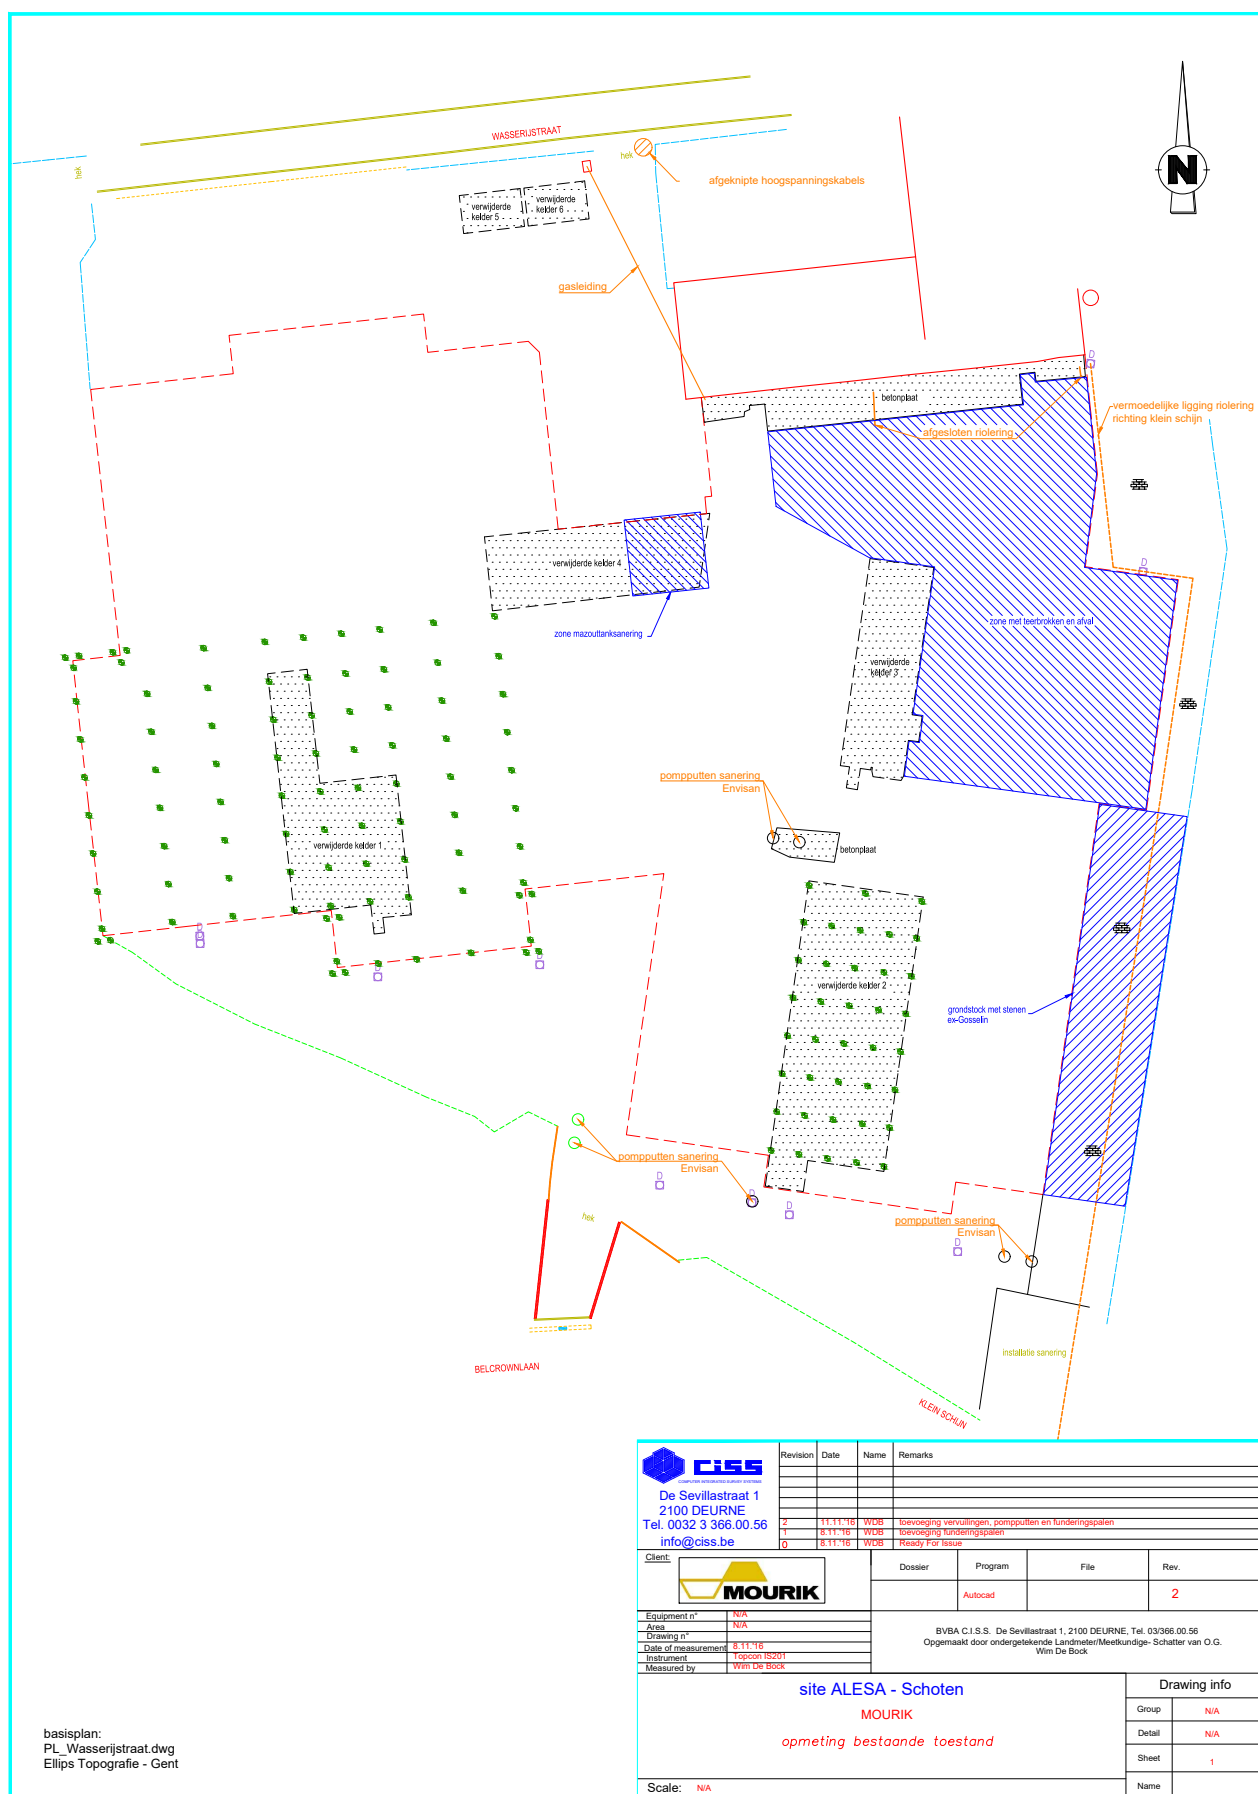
PLAN 11. As Built van de af te breken constructies op de site Alesa. © CISS 8 november 2016
